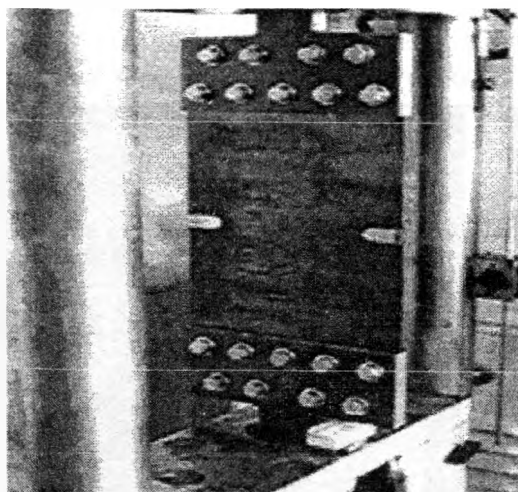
Общий вид листового образца, подготовленного к испытанию
